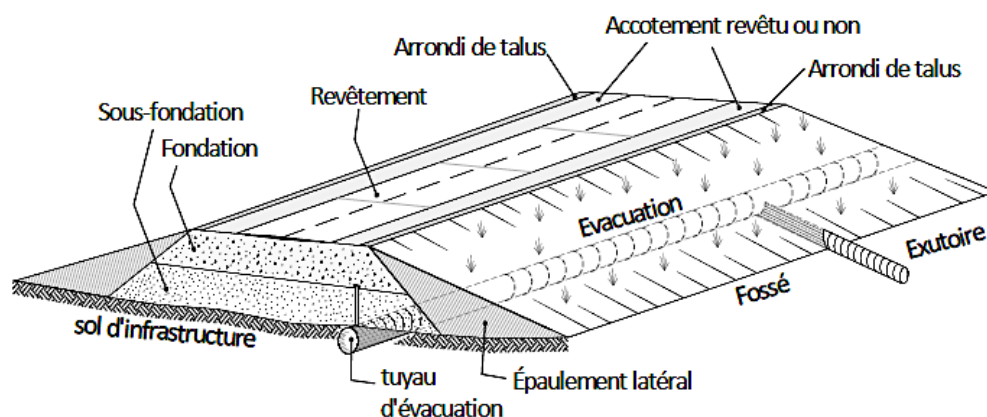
Éléments dans la structure de chaussée (Lafleur, 2013).
